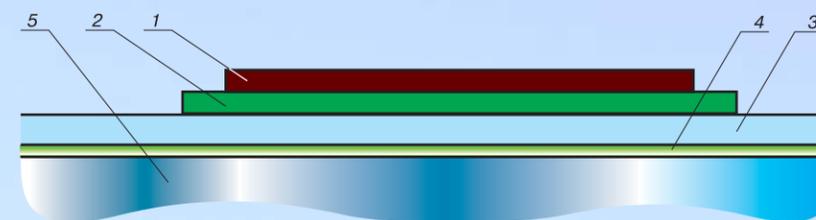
Разрез полотна автозимника с использованием теплоизоляции: 1 – земляное полотно из минерального грунта; 2 – слой теплоизоляции; 3 – снежно-ледяное ядро; 4 – естественный растительный покров (мох); 5 – мерзлое грунтовое основание.
